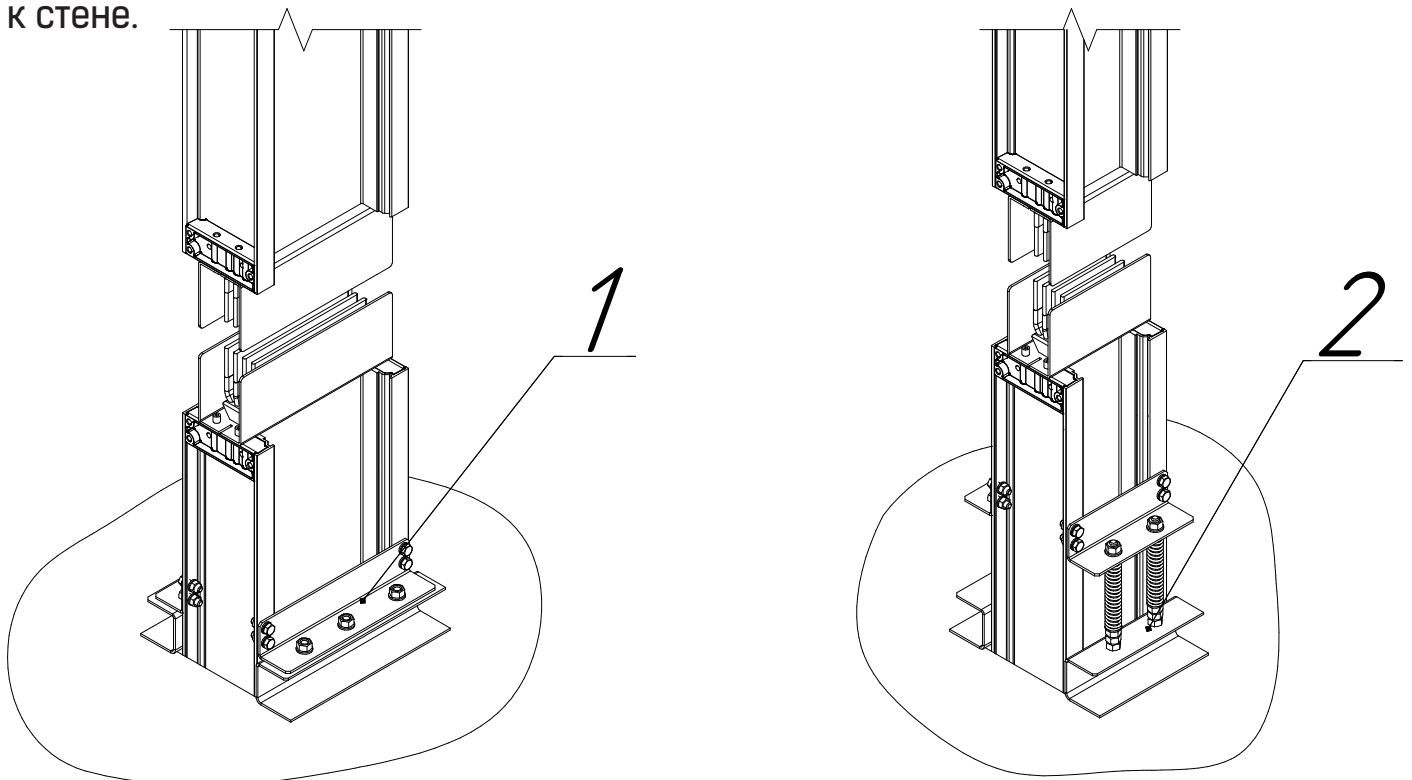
Схема вертикального крепления шинопровода к полу: 1 – жесткое крепление к полу; 2 – пружинное крепление к полу.
